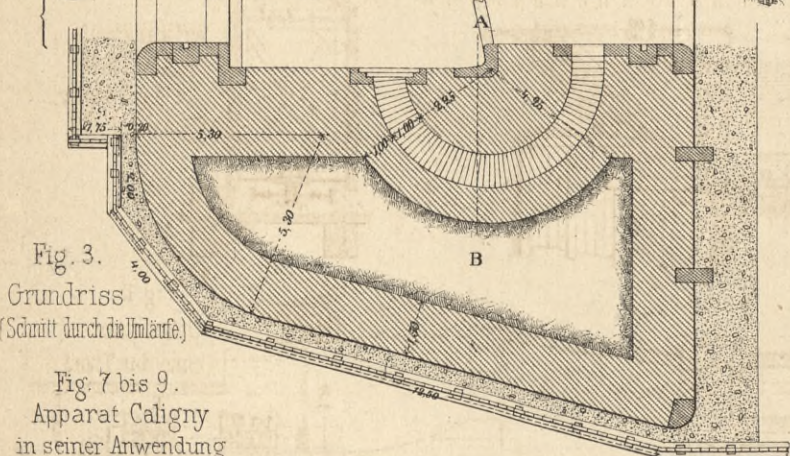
Grundriss (Schnitt durch die Umläufe)
